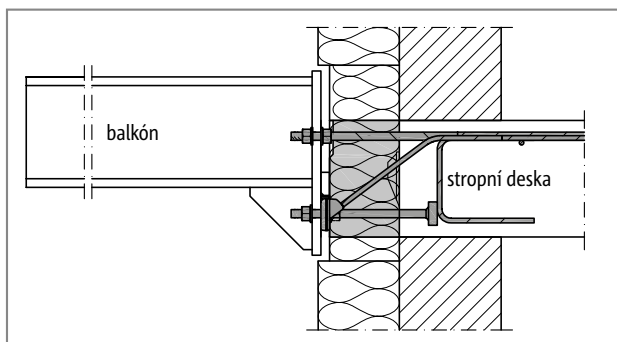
Schöck Isokorb® XT typ SKP: Volně vyložený balkón
